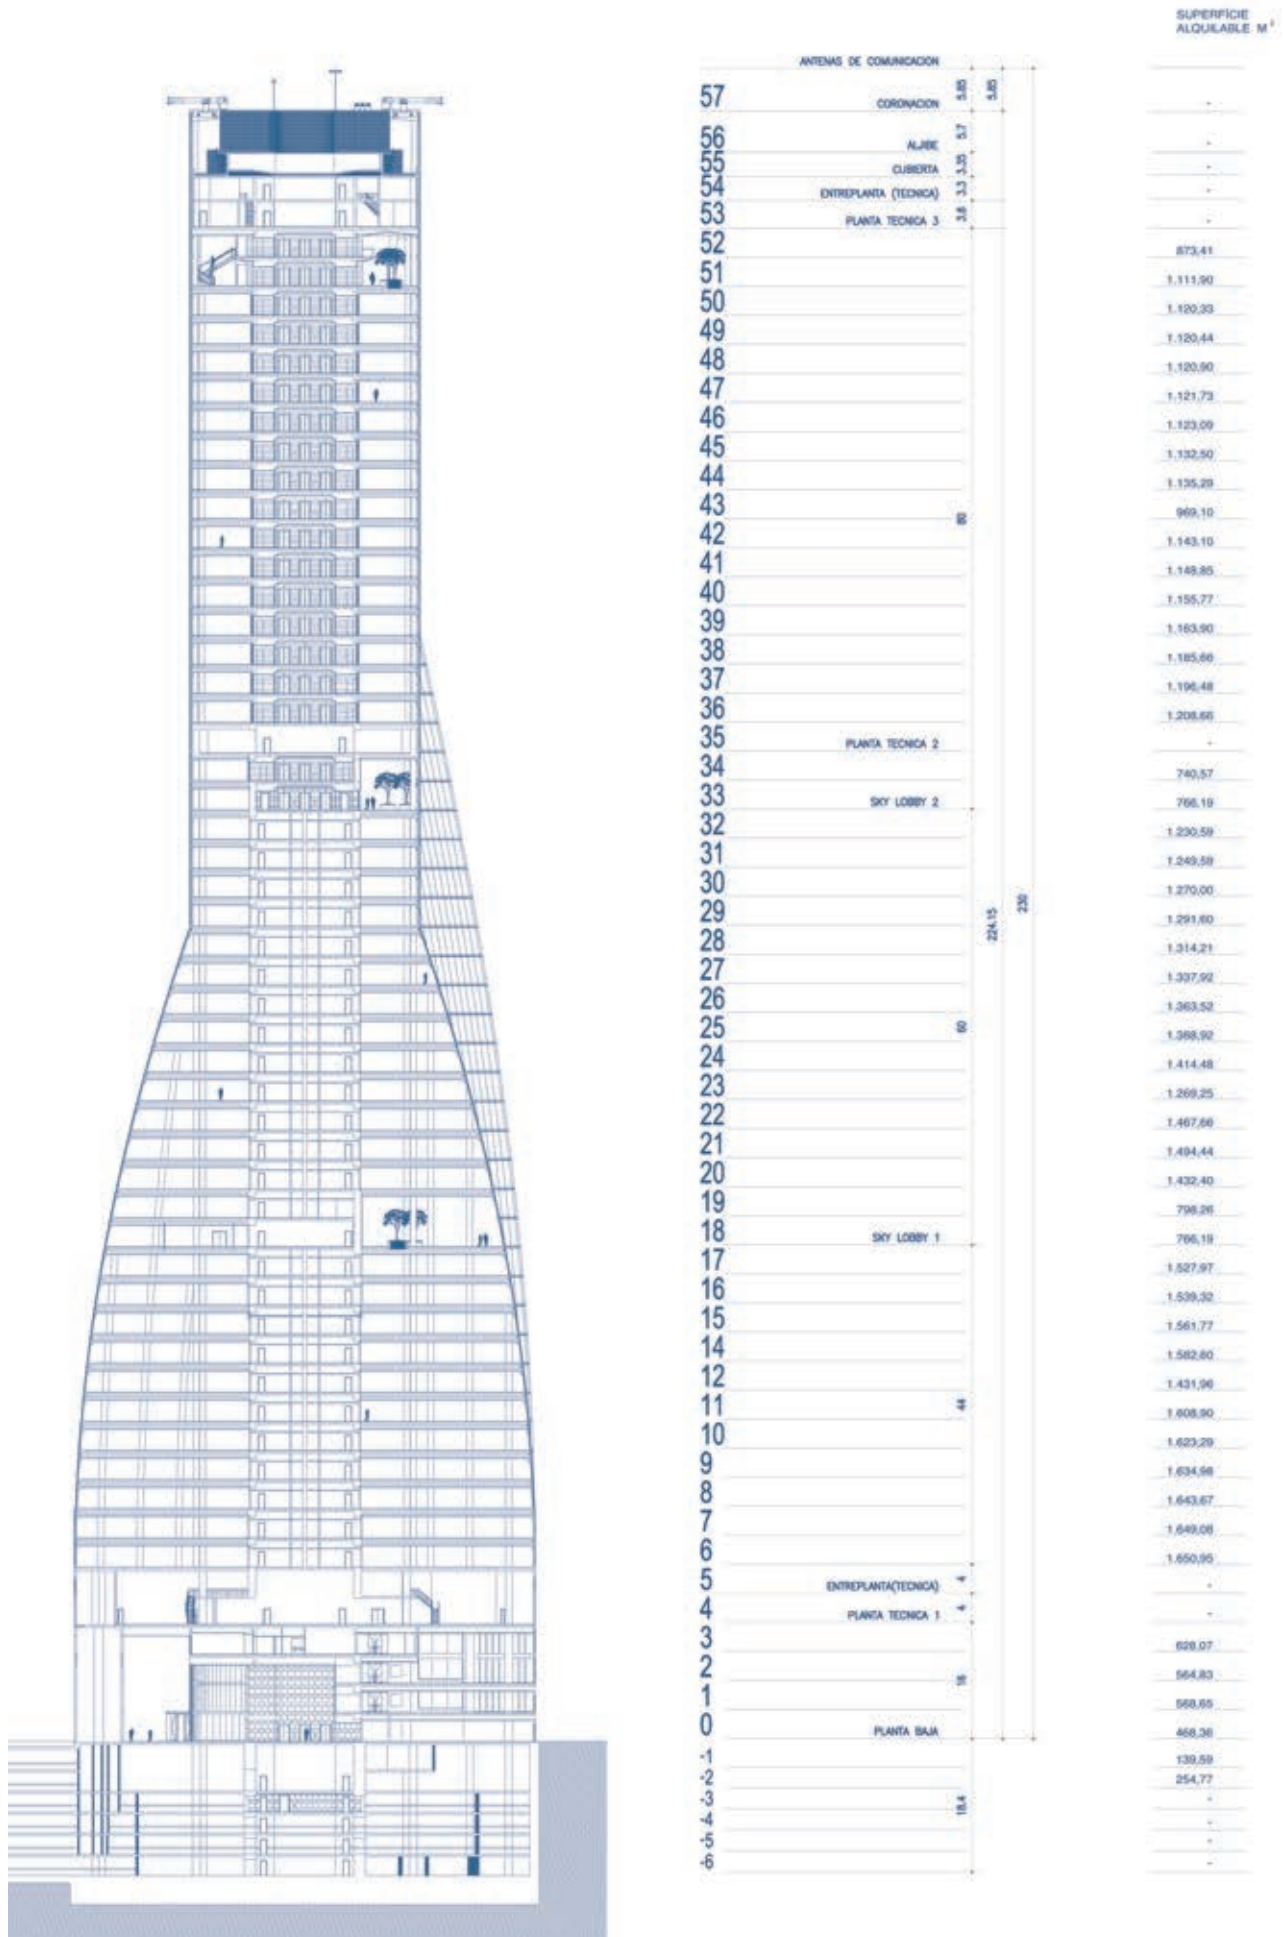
Alzado seccionado de la torre con las diferentes zonas del edificio.
